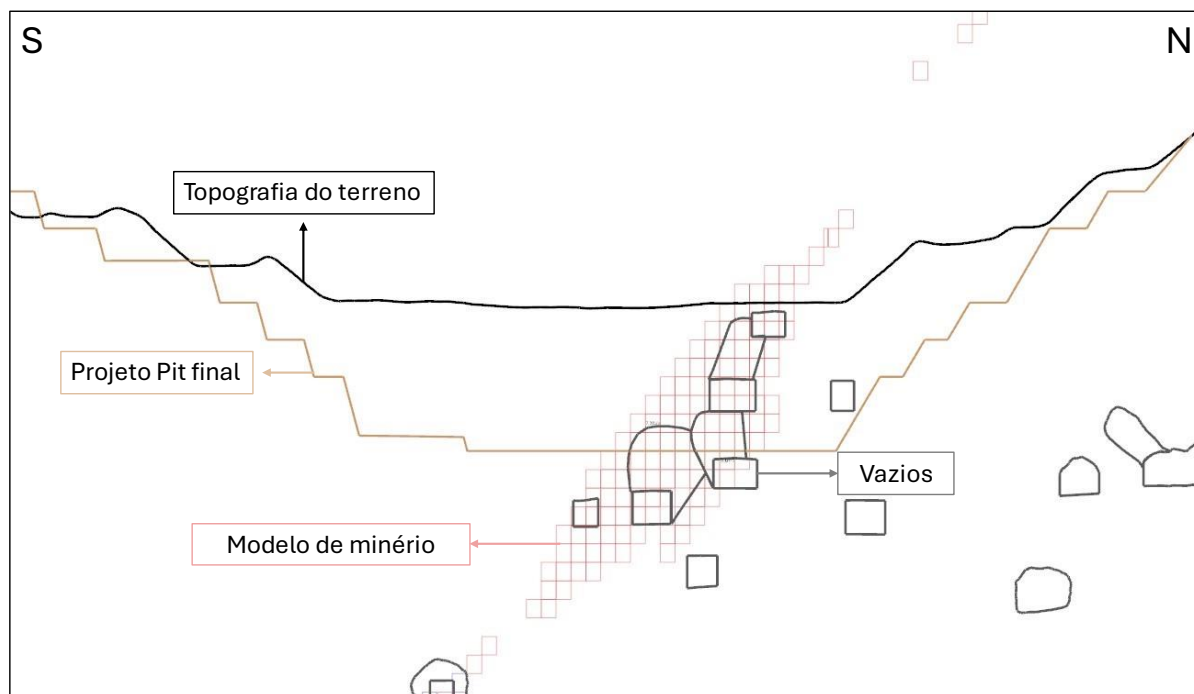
Croqui esquemático representado em seção indicando interação entre *Open Pit* e subsolo.
